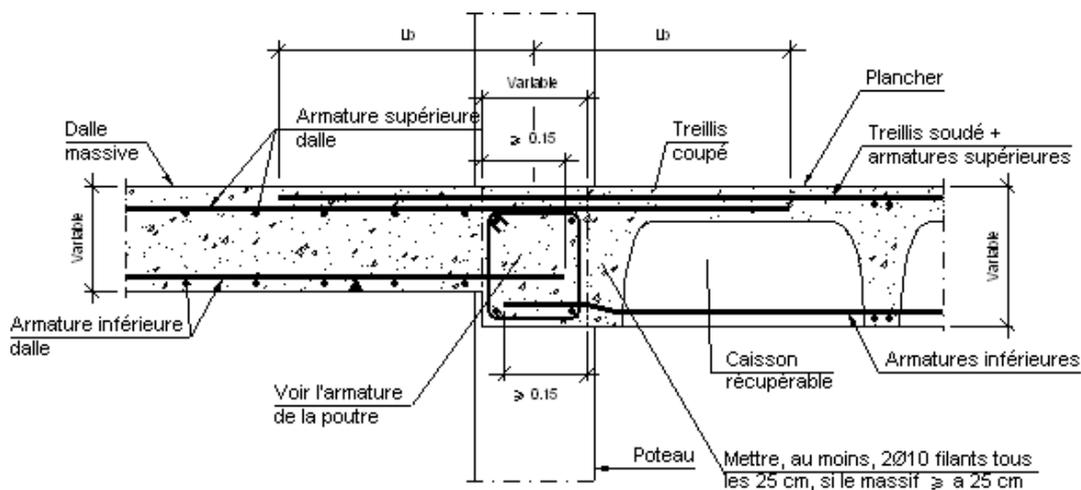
Schéma constructif d'une dalle a caisson ¹²⁷
